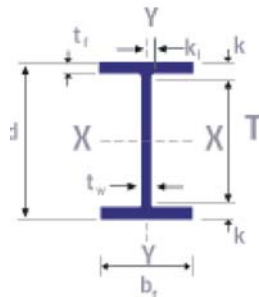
Corte seccionado de vigueta IPR, como aparece en tablas del grupo Collado en su página de Internet www.gcollado.com
